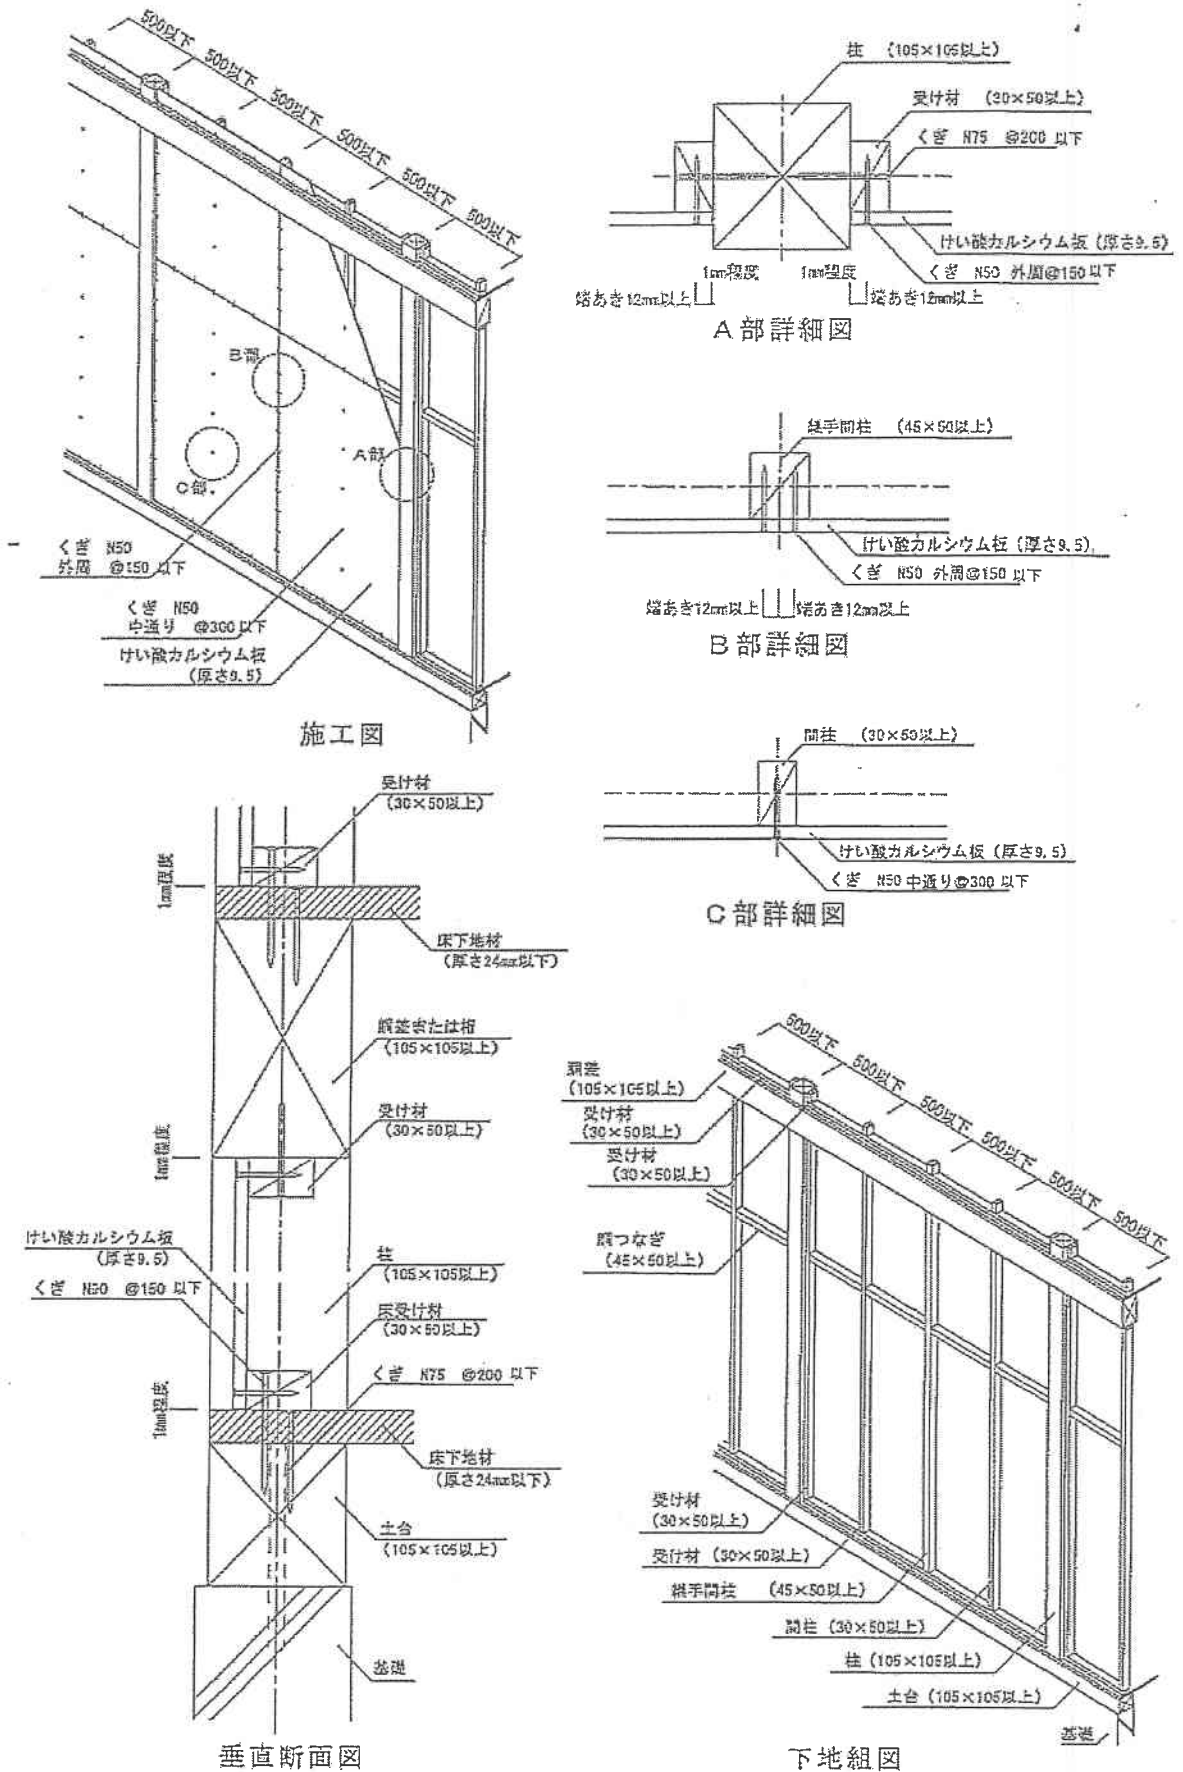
施工図：継手を設ける場合 (寸法単位：mm)
